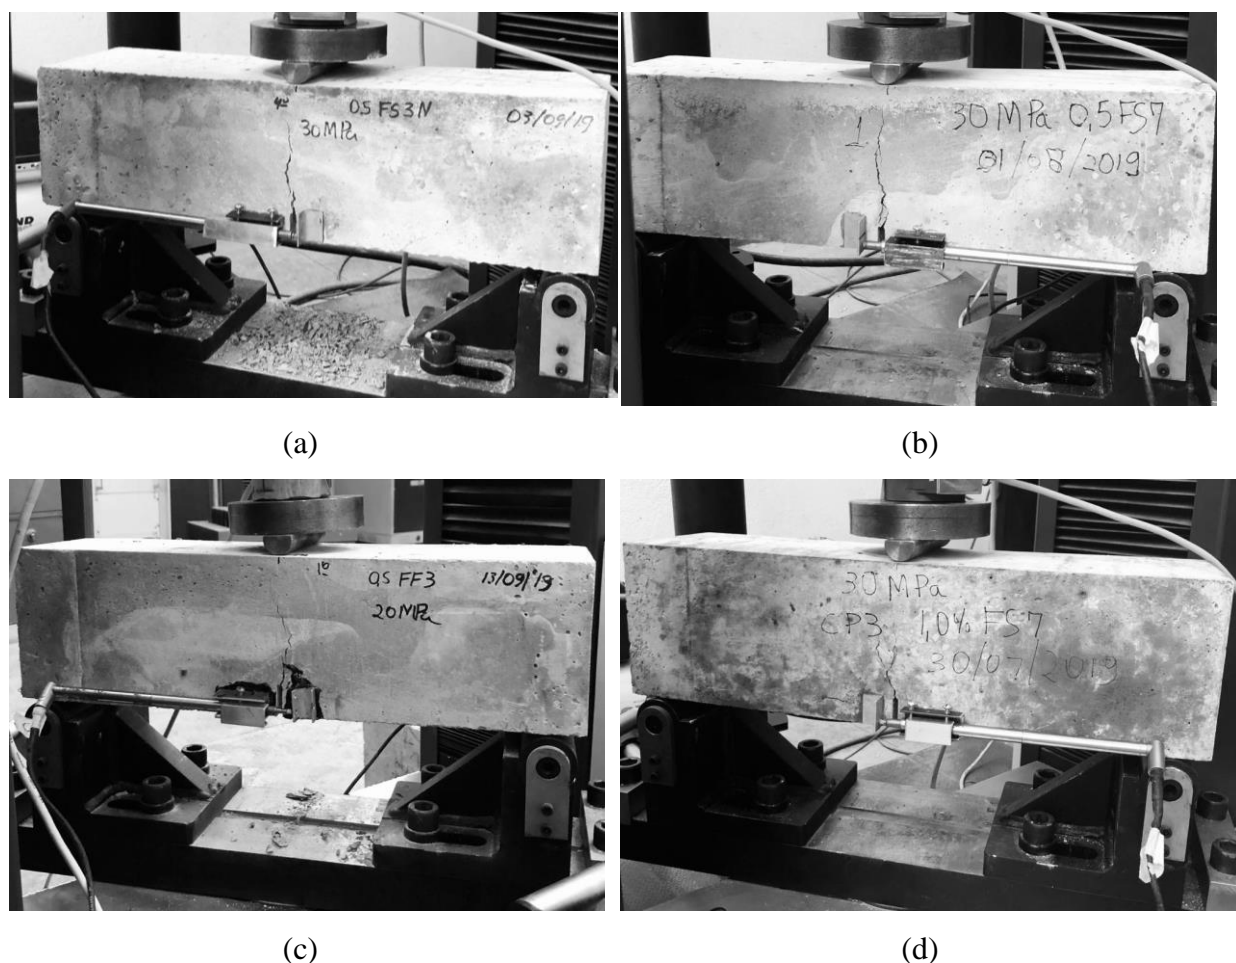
Tipos de ruptura observados no ensaio de flexão a três pontos. (a) uma única fissura vertical, (b) e (c) desvio das fissuras, (d) múltiplas fissuras em uma região central.
